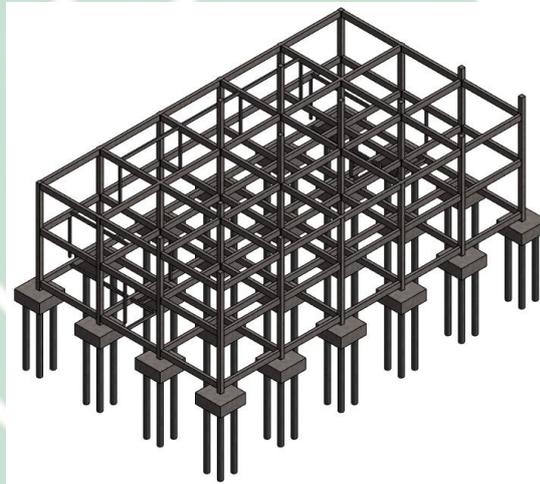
15 Rencana Pondasi Bangunan Musala
